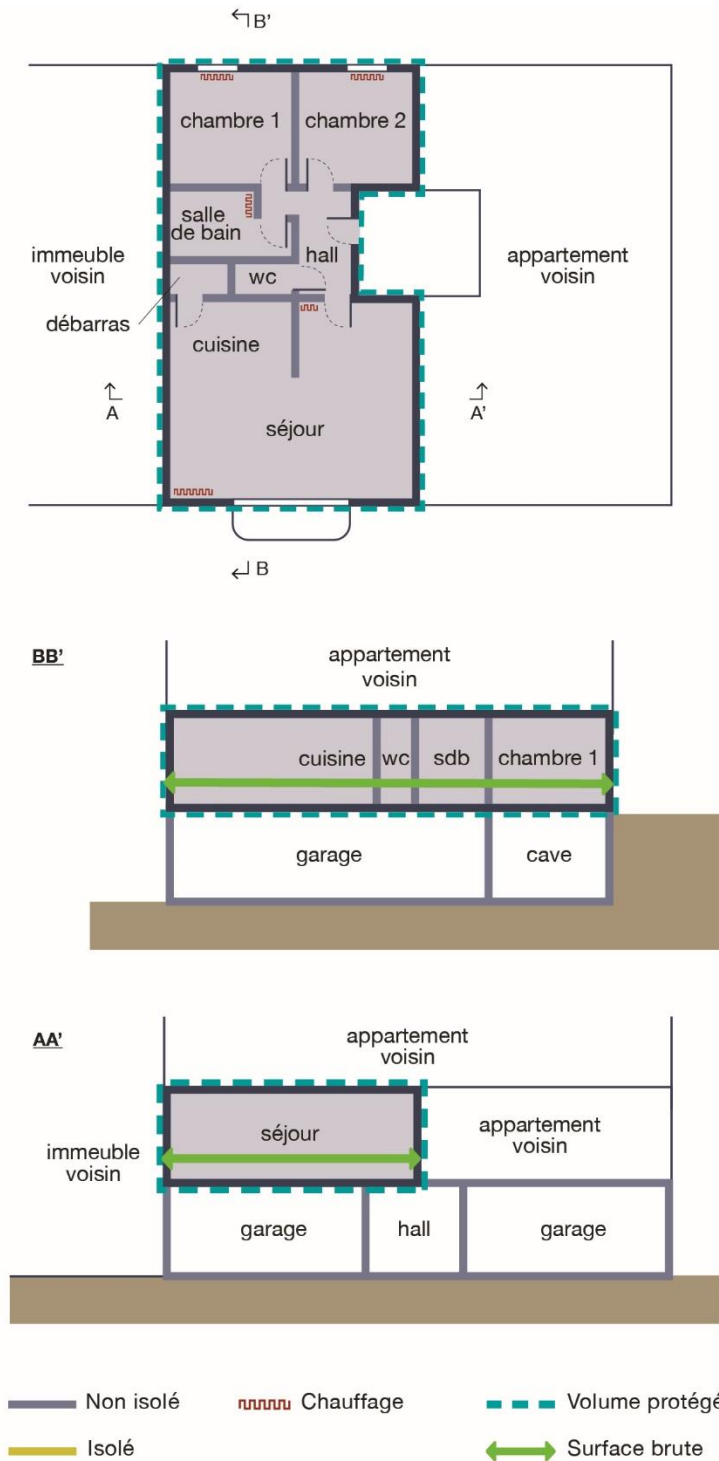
Vue en plan et en coupe d'un appartement avec espaces communs
